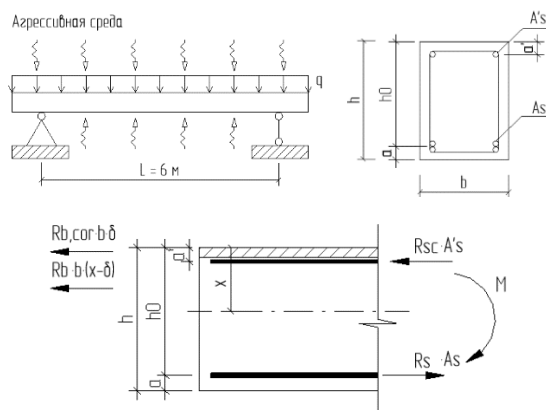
Расчетная схема балки. Схема усилий в сечении
